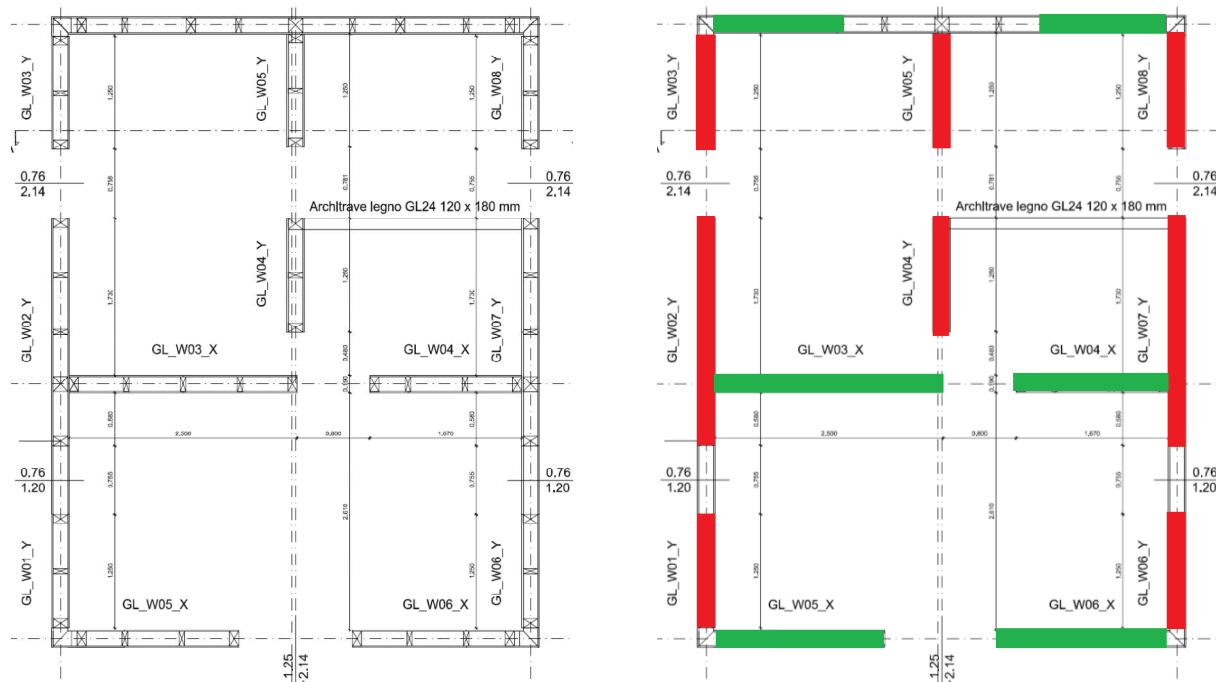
Sx: disposizione in pianta. Dx: pareti strutturali nelle due direzioni
